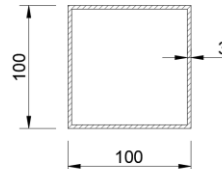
Perfiles metálicos, vigas principales y secundarias
